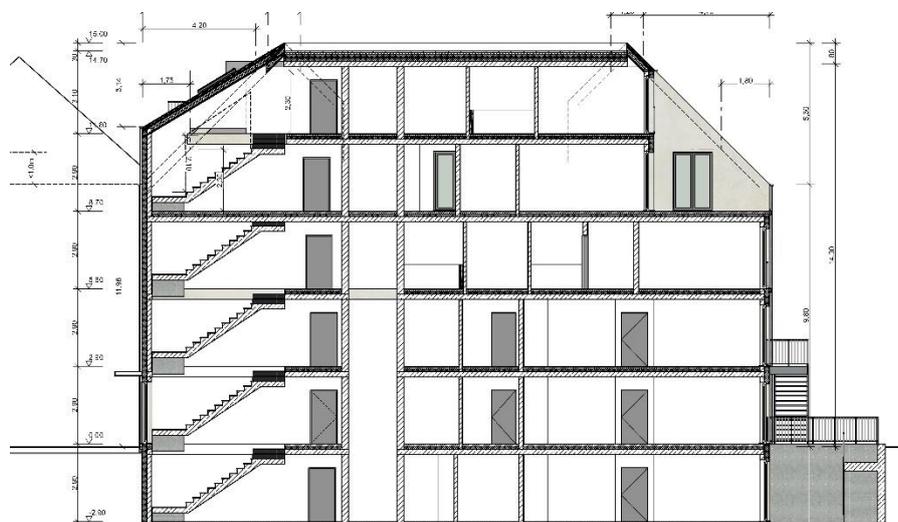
Schnitt des geplanten Gebäudes, o. M. (Quelle: Arch. Anja Dohle, Paderborn, 02/2023)
